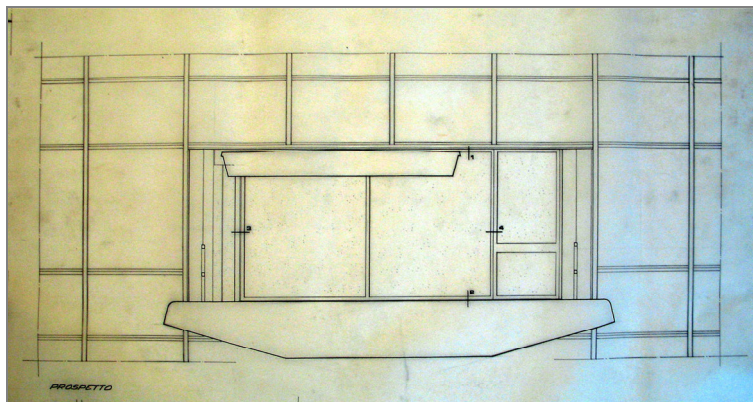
proposta di ristrutturazione generale – nuova sistemazione bussola ingresso piano primo - PROSPETTO (fonte CSAC , stralcio tav. 71, archivio n. 371-1)
